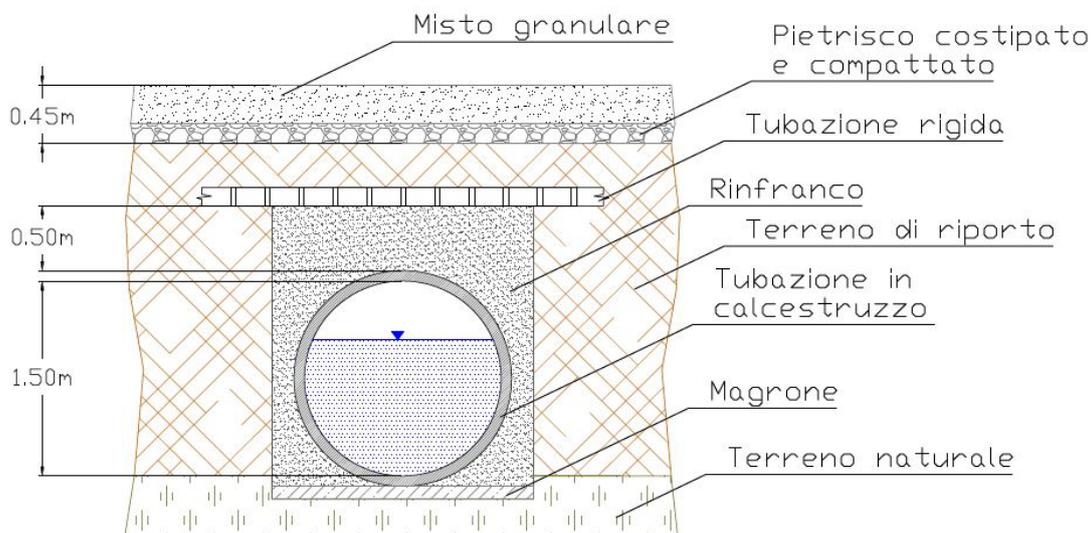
Sezione tipo alla mezzzeria della strada nel punto di interferenza “Accesso FV4”
